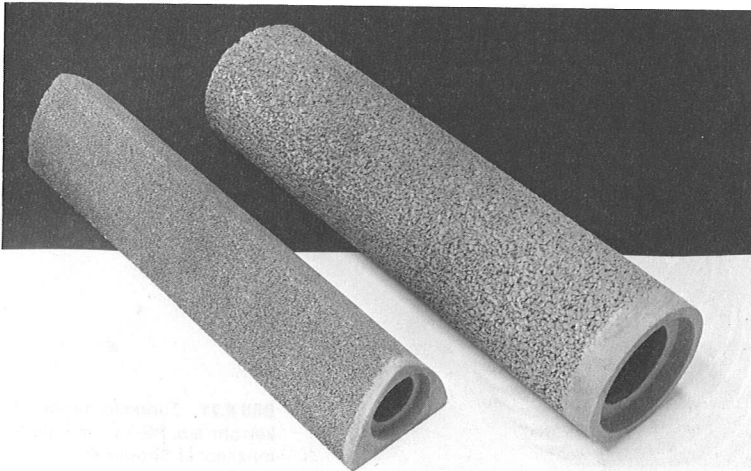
Betonfilterrohre aus Einkornbeton Porosit®
